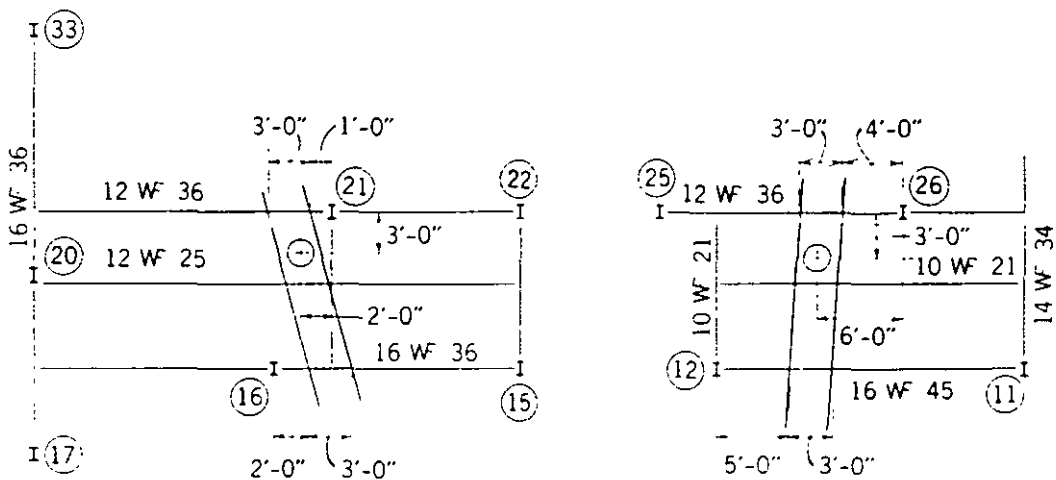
Croquis típico, mostrando la localización de las vigas de levantamiento. ⊗ indica la localización de la pluma.
